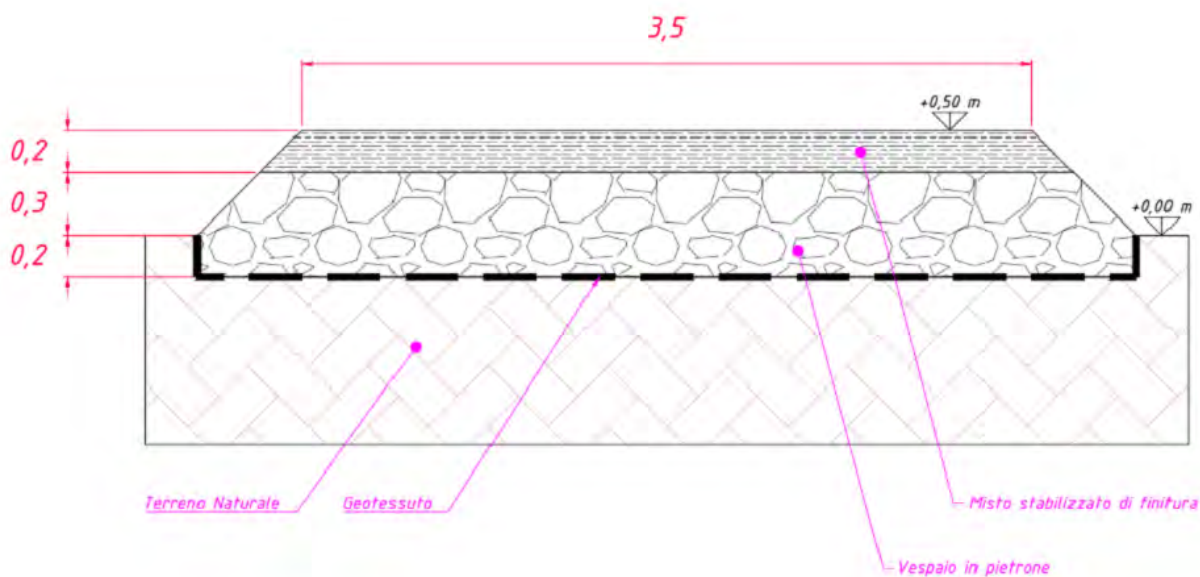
Sezione tipo viabilità interna dell'impianto e piazzali
